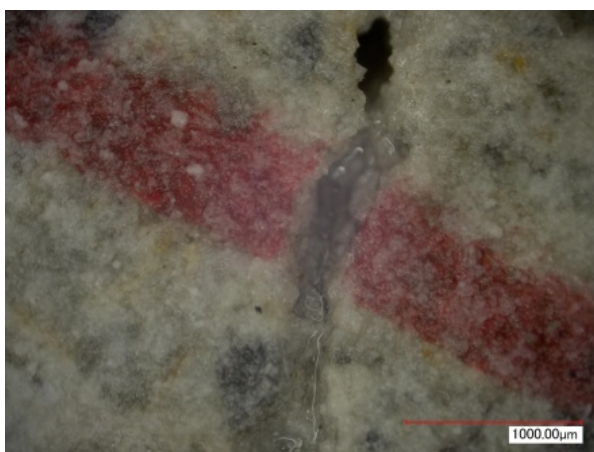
表面ひび割れ部状況 (182 日後)
